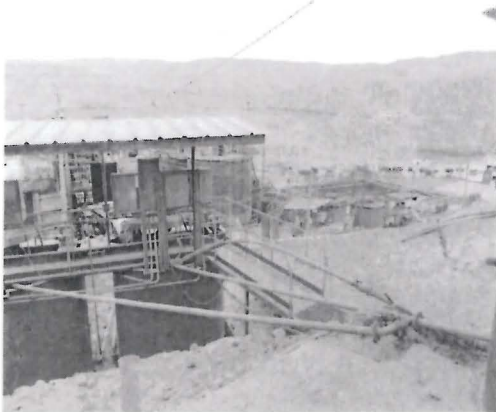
HALLAZGO N° 01, Tanque metálico de preparación de solución de cianuro de sodio, capacidad 10 m3, se encuentra apoyado sobre una base de concreto.
